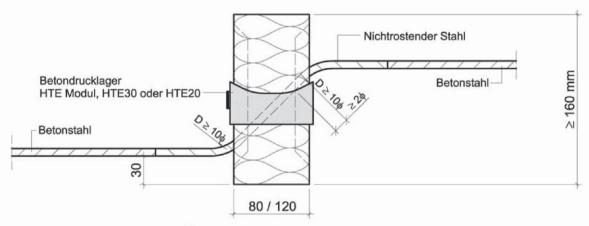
Schöck Isokorb® Typ Q mit Betondrucklager
